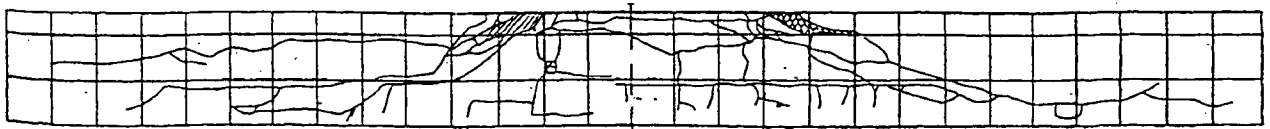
RC39+鋼板-2 供試体の破壊状況
